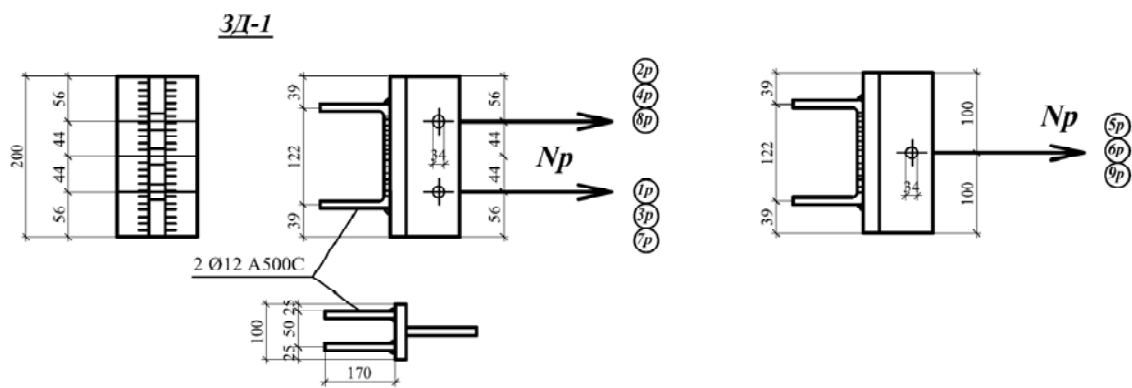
Конструкция и армирование опытных образцов-балок III-A серии.
